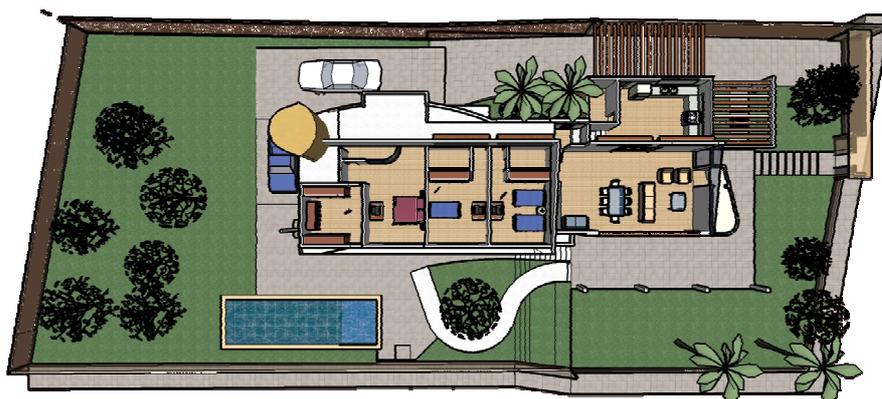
Maquete eletrônica (planta baixa do pavimento térreo)
